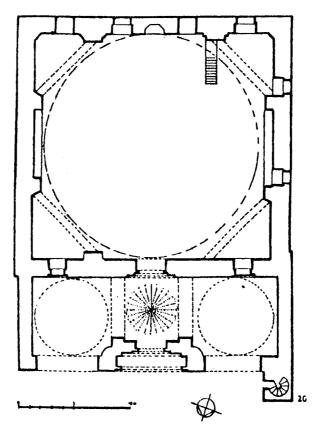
مسقط أفقي لجامع حاجي اوزبك في ازنيق. (عن: Goodwin).
